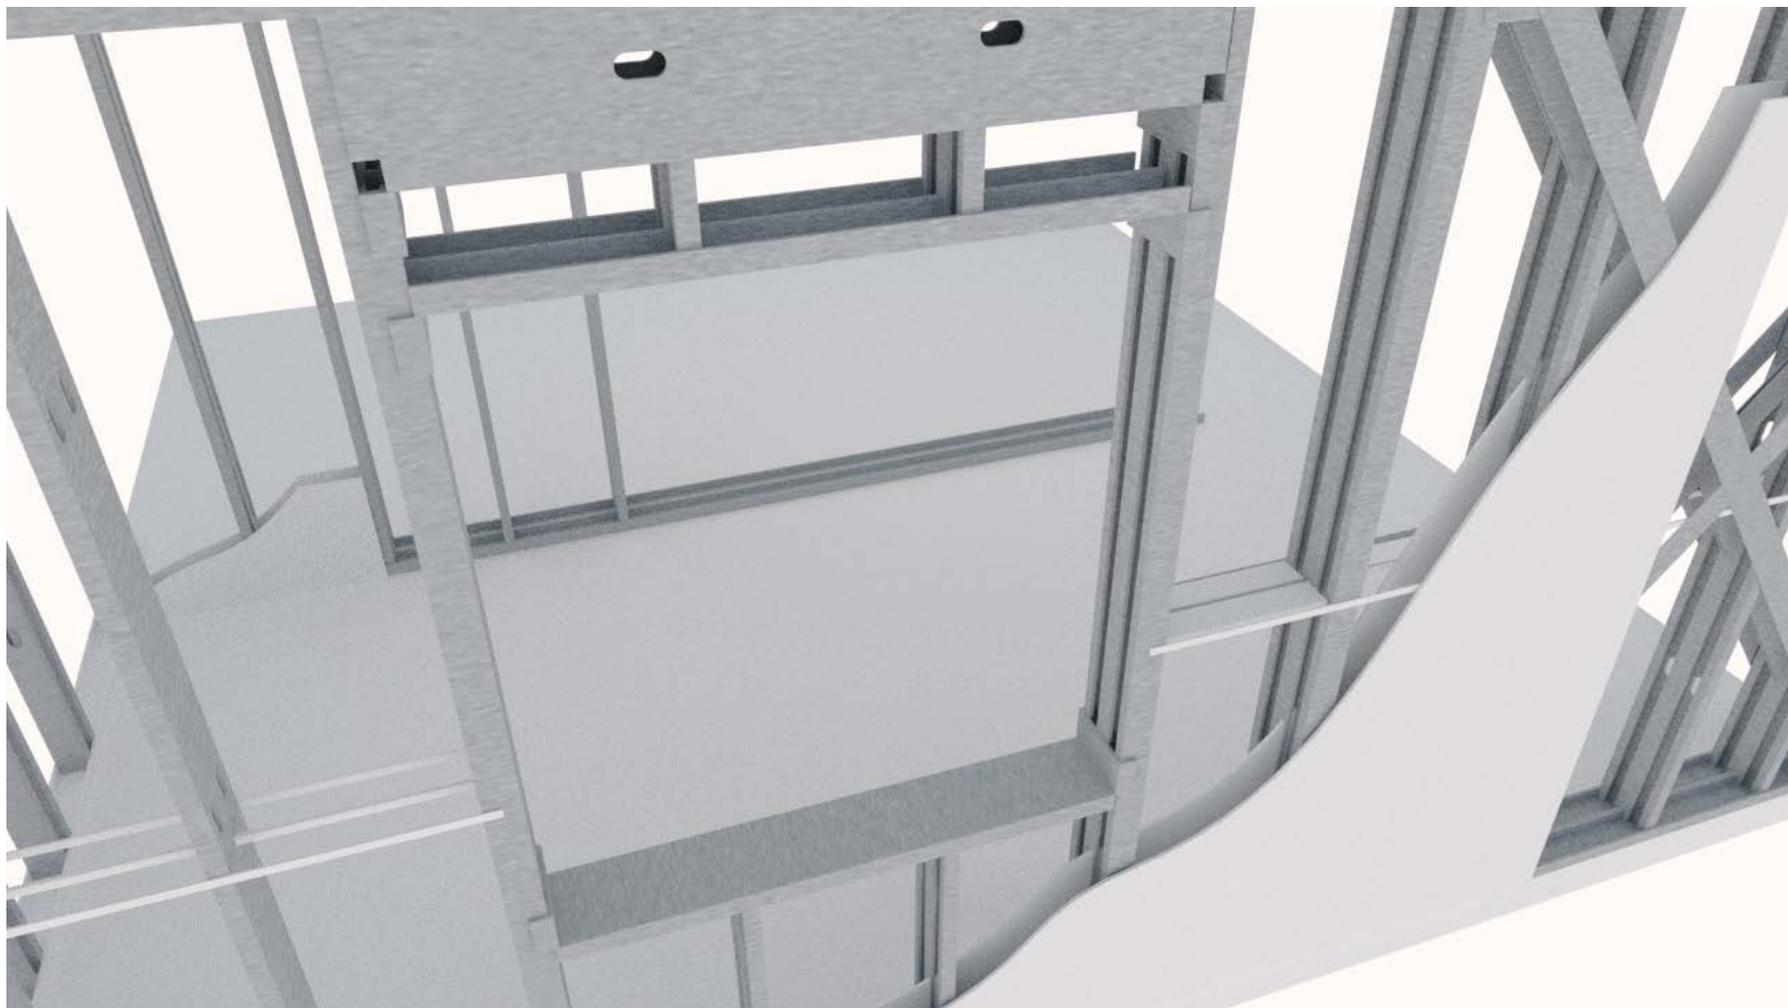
Andino, E. (2020)*. Vista detalle de construcción de ventana. Elaboración propia.
